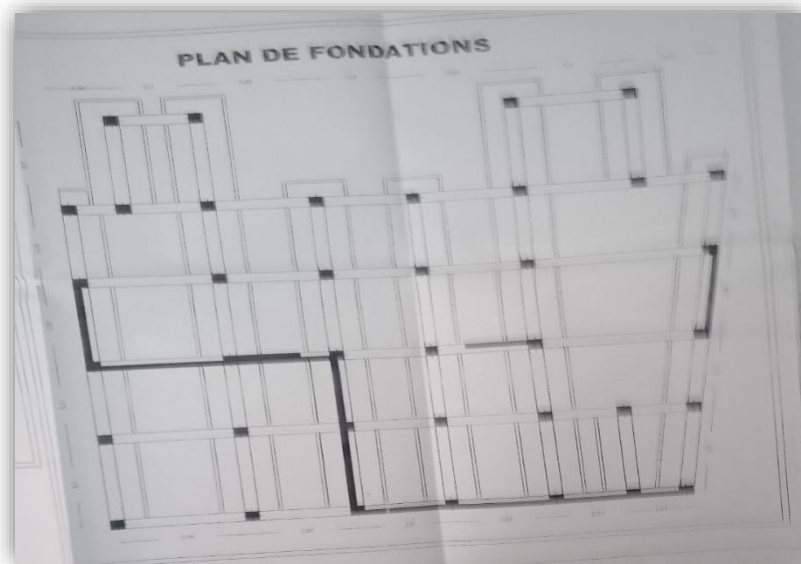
Plan de fondation de la structure inspectée.
